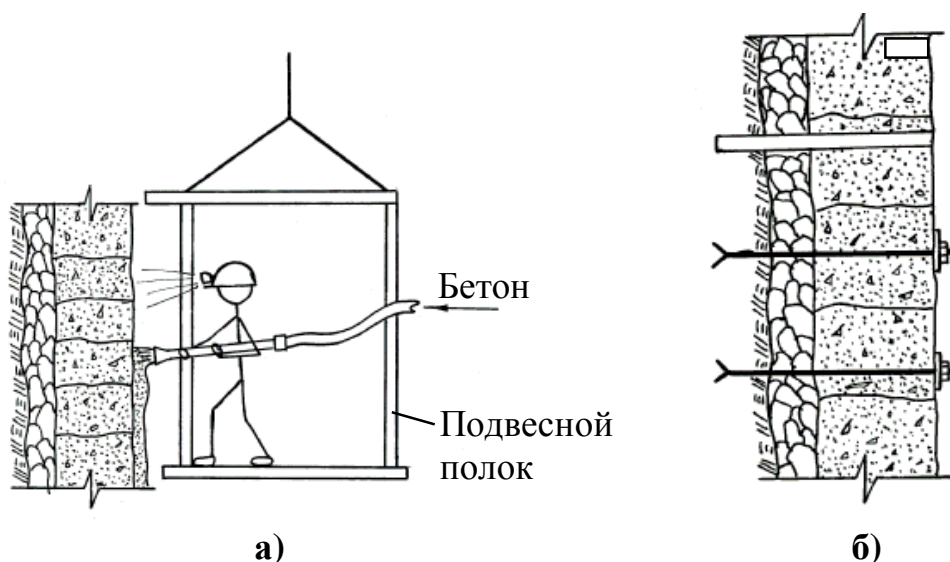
Схемы укрепления бетонных крепей в стволе с нанесением набрызгбетон (а) и возведением анкеров со скрепляющим раствором (б)
